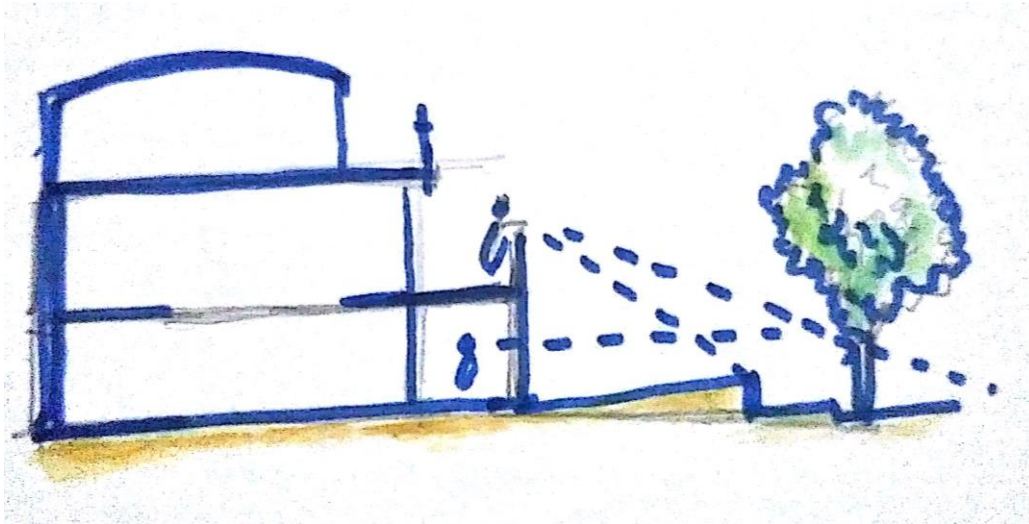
28 Skematik Bukaan dan Fasad Bangunan
